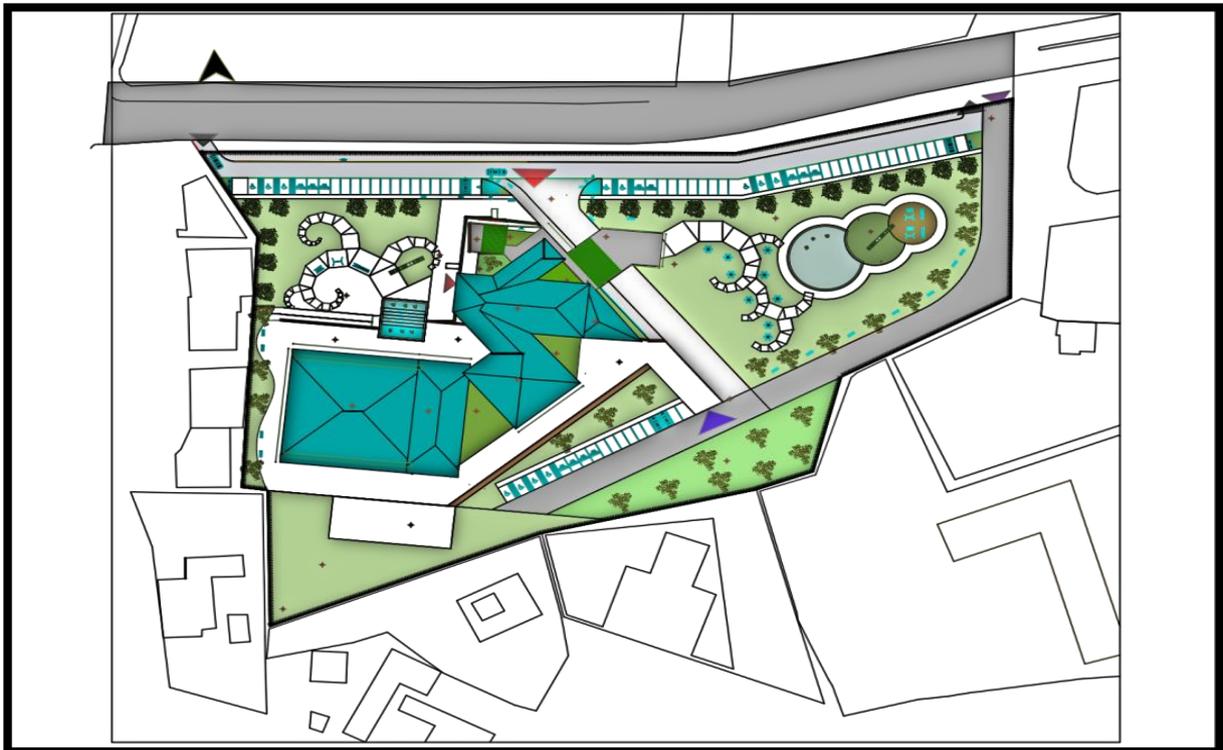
Plan de masse Ech : 1/750 (source : auteur)
